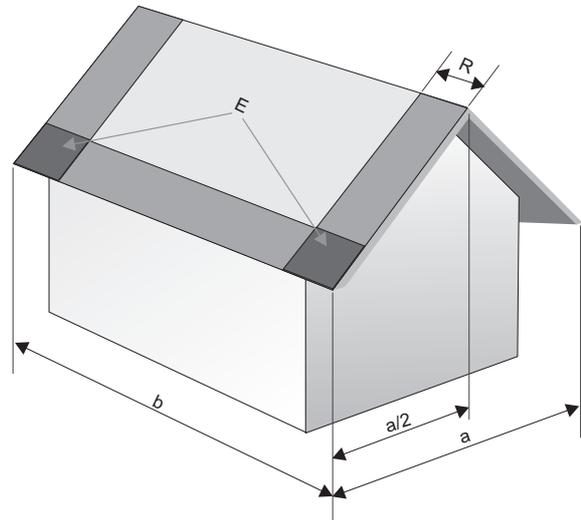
Ermittlung von Rand- und Eckbereichen an Schrägdächern unter 35° Neigung: a = kürzere Seite des Dachgrundriss (Gebäudebreite + Dachüberstand), b = lange Seite des Dachgrundriss (Gebäuelänge + Dachüberstand), R = Randbereich, E = Eckbereich
